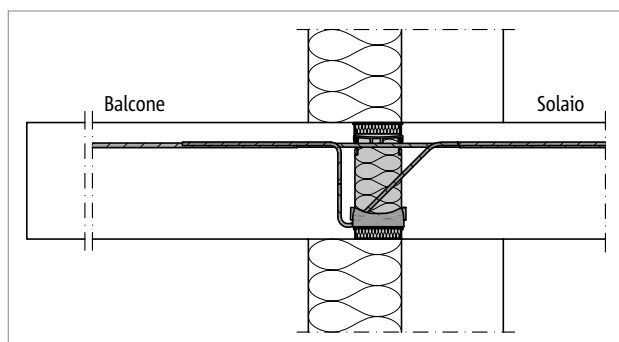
Schöck Isokorb® T tipo KL: raccordo con sistema di isolamento a cappotto
